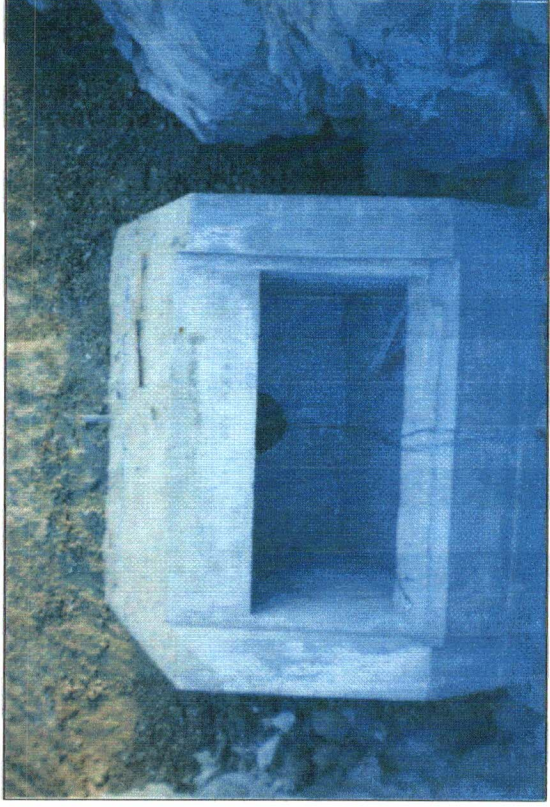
Vista frontal da caixa de entrada da tomada d'água.
